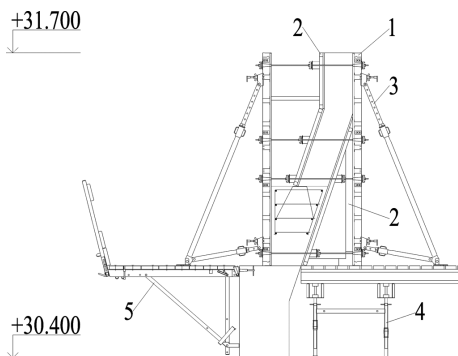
Схема опалубки наклонных стен шатра Храма:
